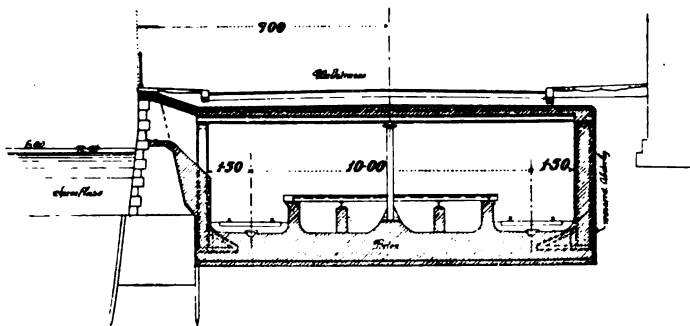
Querschnitt durch die Haltestelle Spittelmarkt der Berliner Untergrundbahn.
